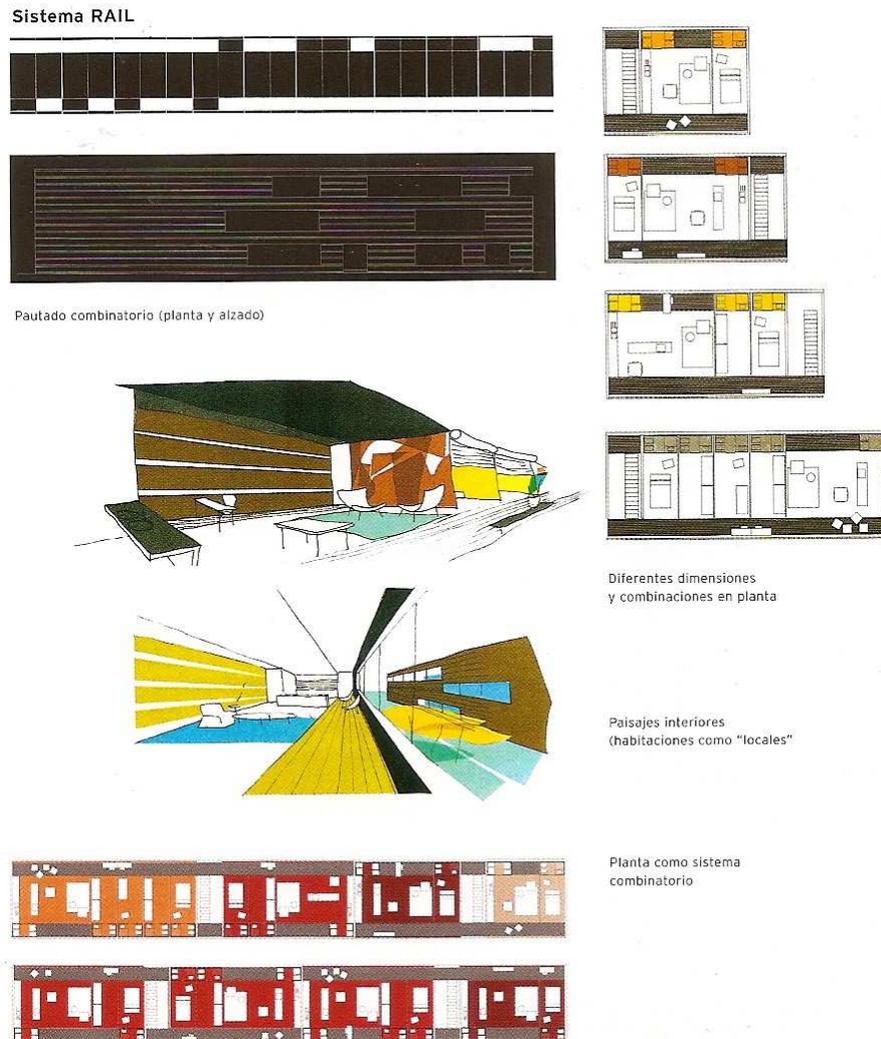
Esquemas y plantas Sistema RAIL; Fuente: (GAUSA, 1998, pág. 27)
